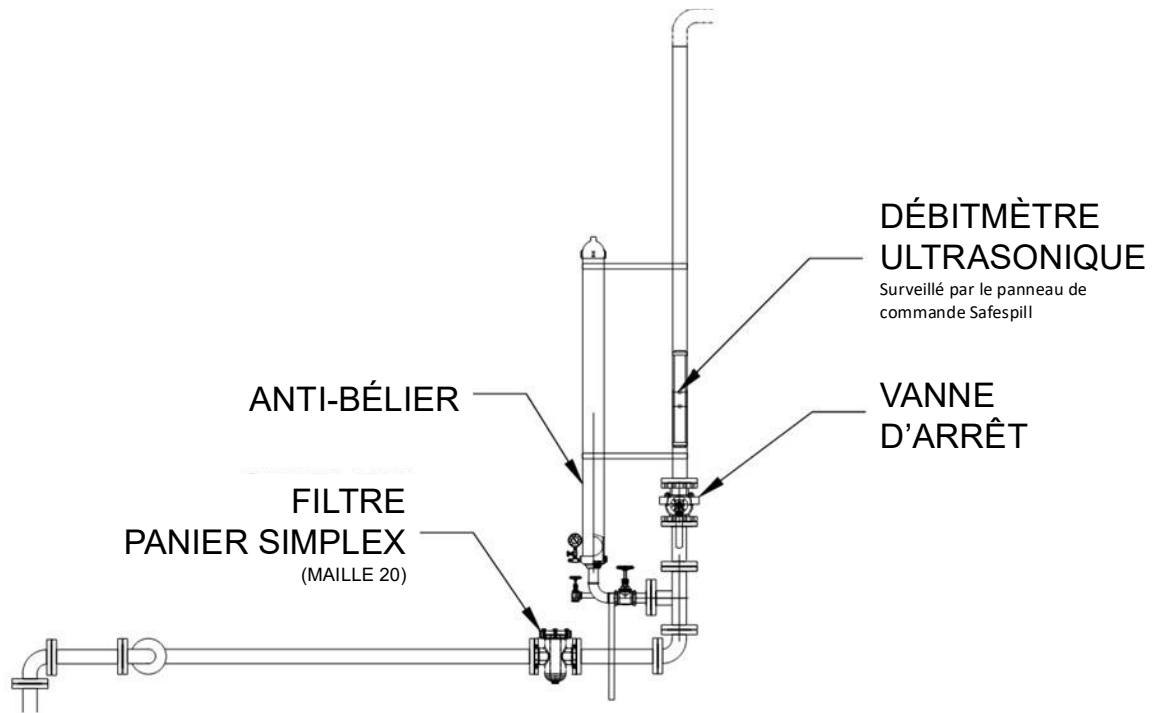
Exemple d'agencement d'alimentation en eau avec les dispositifs nécessaires.
